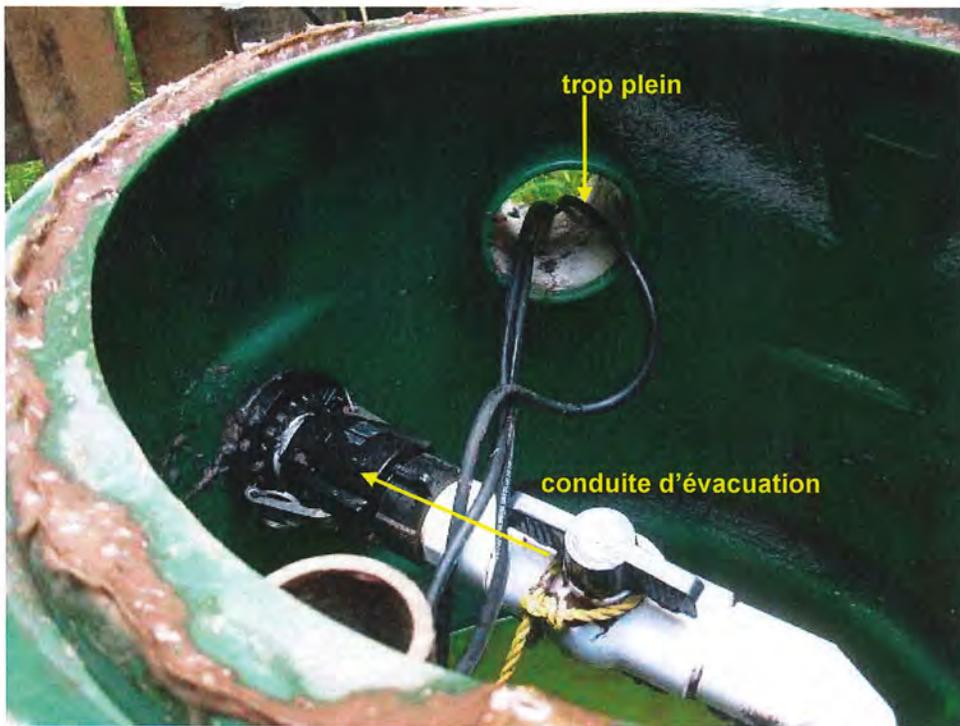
Station de pompage 1A située au sud du site 517 – traces de débordement
